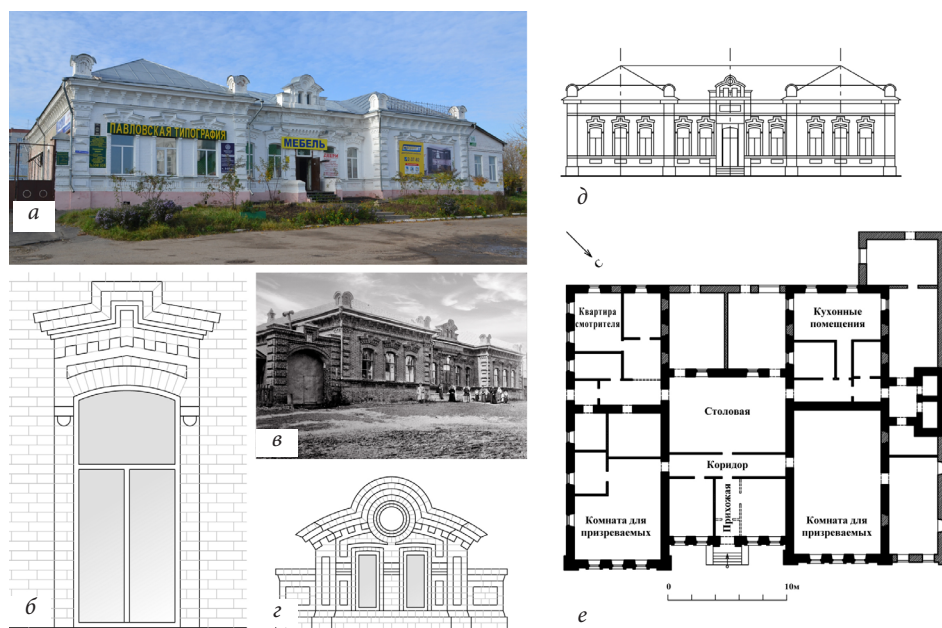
Богадельня, построенная на средства Г. Н. Рябининой (ул. Шмидта, 6), 1889–1892 гг.: *а* – общий вид; *б* – окно; *в* – первоначальный вид (фото начала XX в.); *г* – аттик; *д* – схема фасада; *е* – план 1-го этажа
